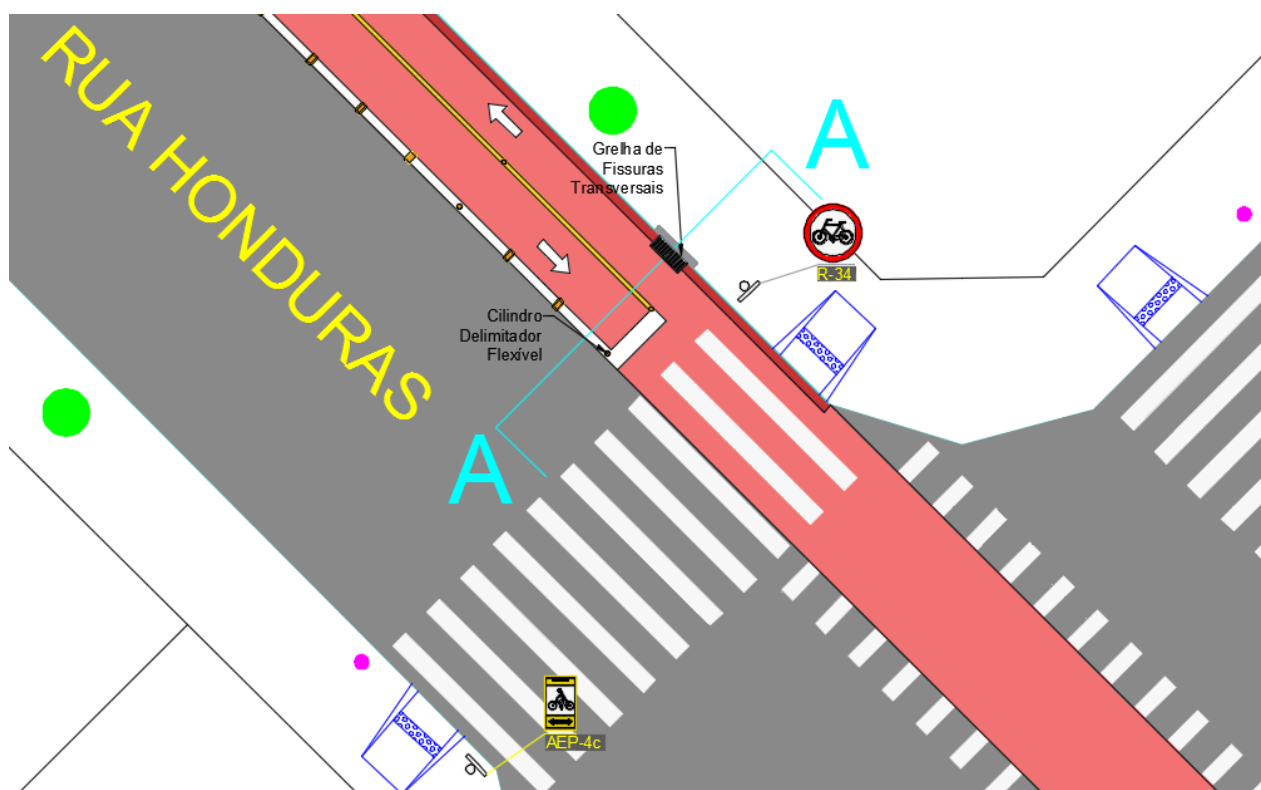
Planta com a proposta de intervenção (Fonte: Autoria própria)
